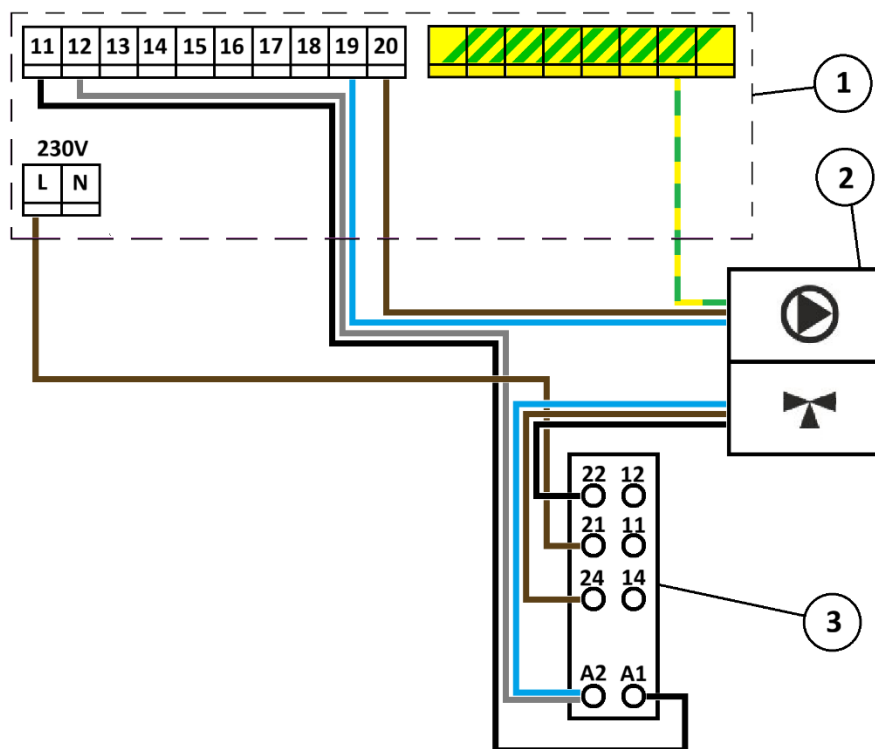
Anschluss der Pumpengruppe, wobei: 1 – Regler, 2 – Pumpengruppe, 3 – Relais
